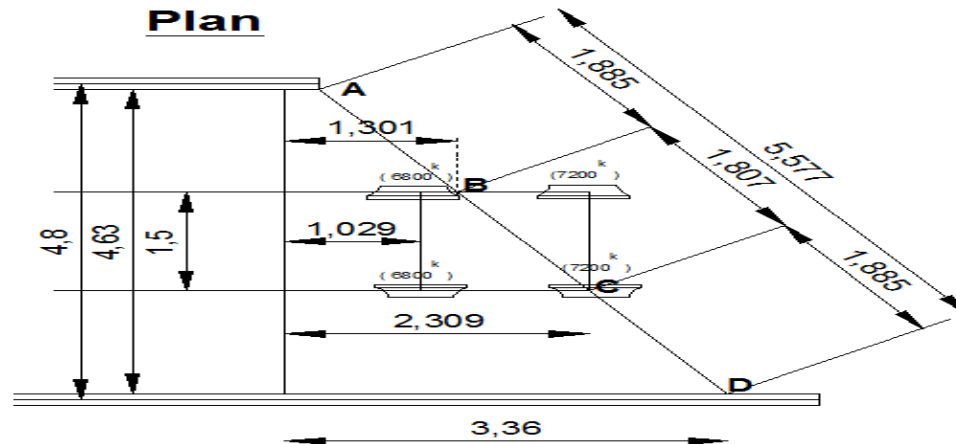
Vue en plan du tablier du côté de la poutre biaisée
